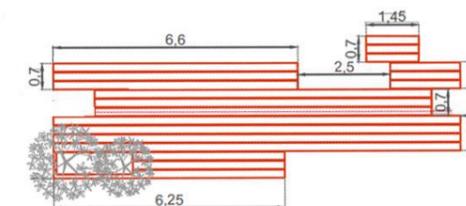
Planta banco tipo 2 en la plaza al norte de la estación. Fuente: Elaboración propia.
